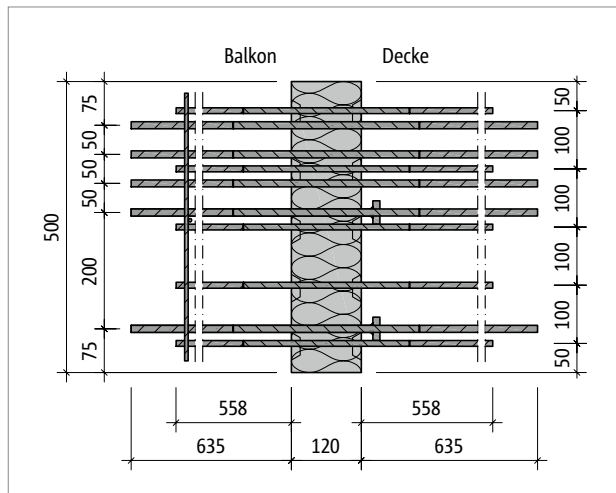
Schöck Isokorb® XT Typ CL-L-M1-V1: Produktgrundriss
